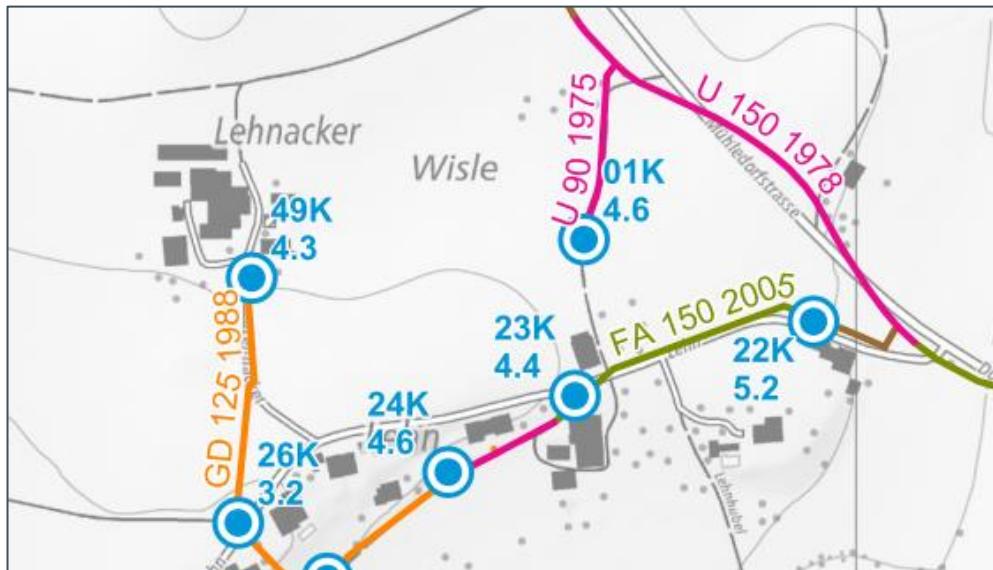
Illustration de la vue en plan Plan de la structure d'âge
